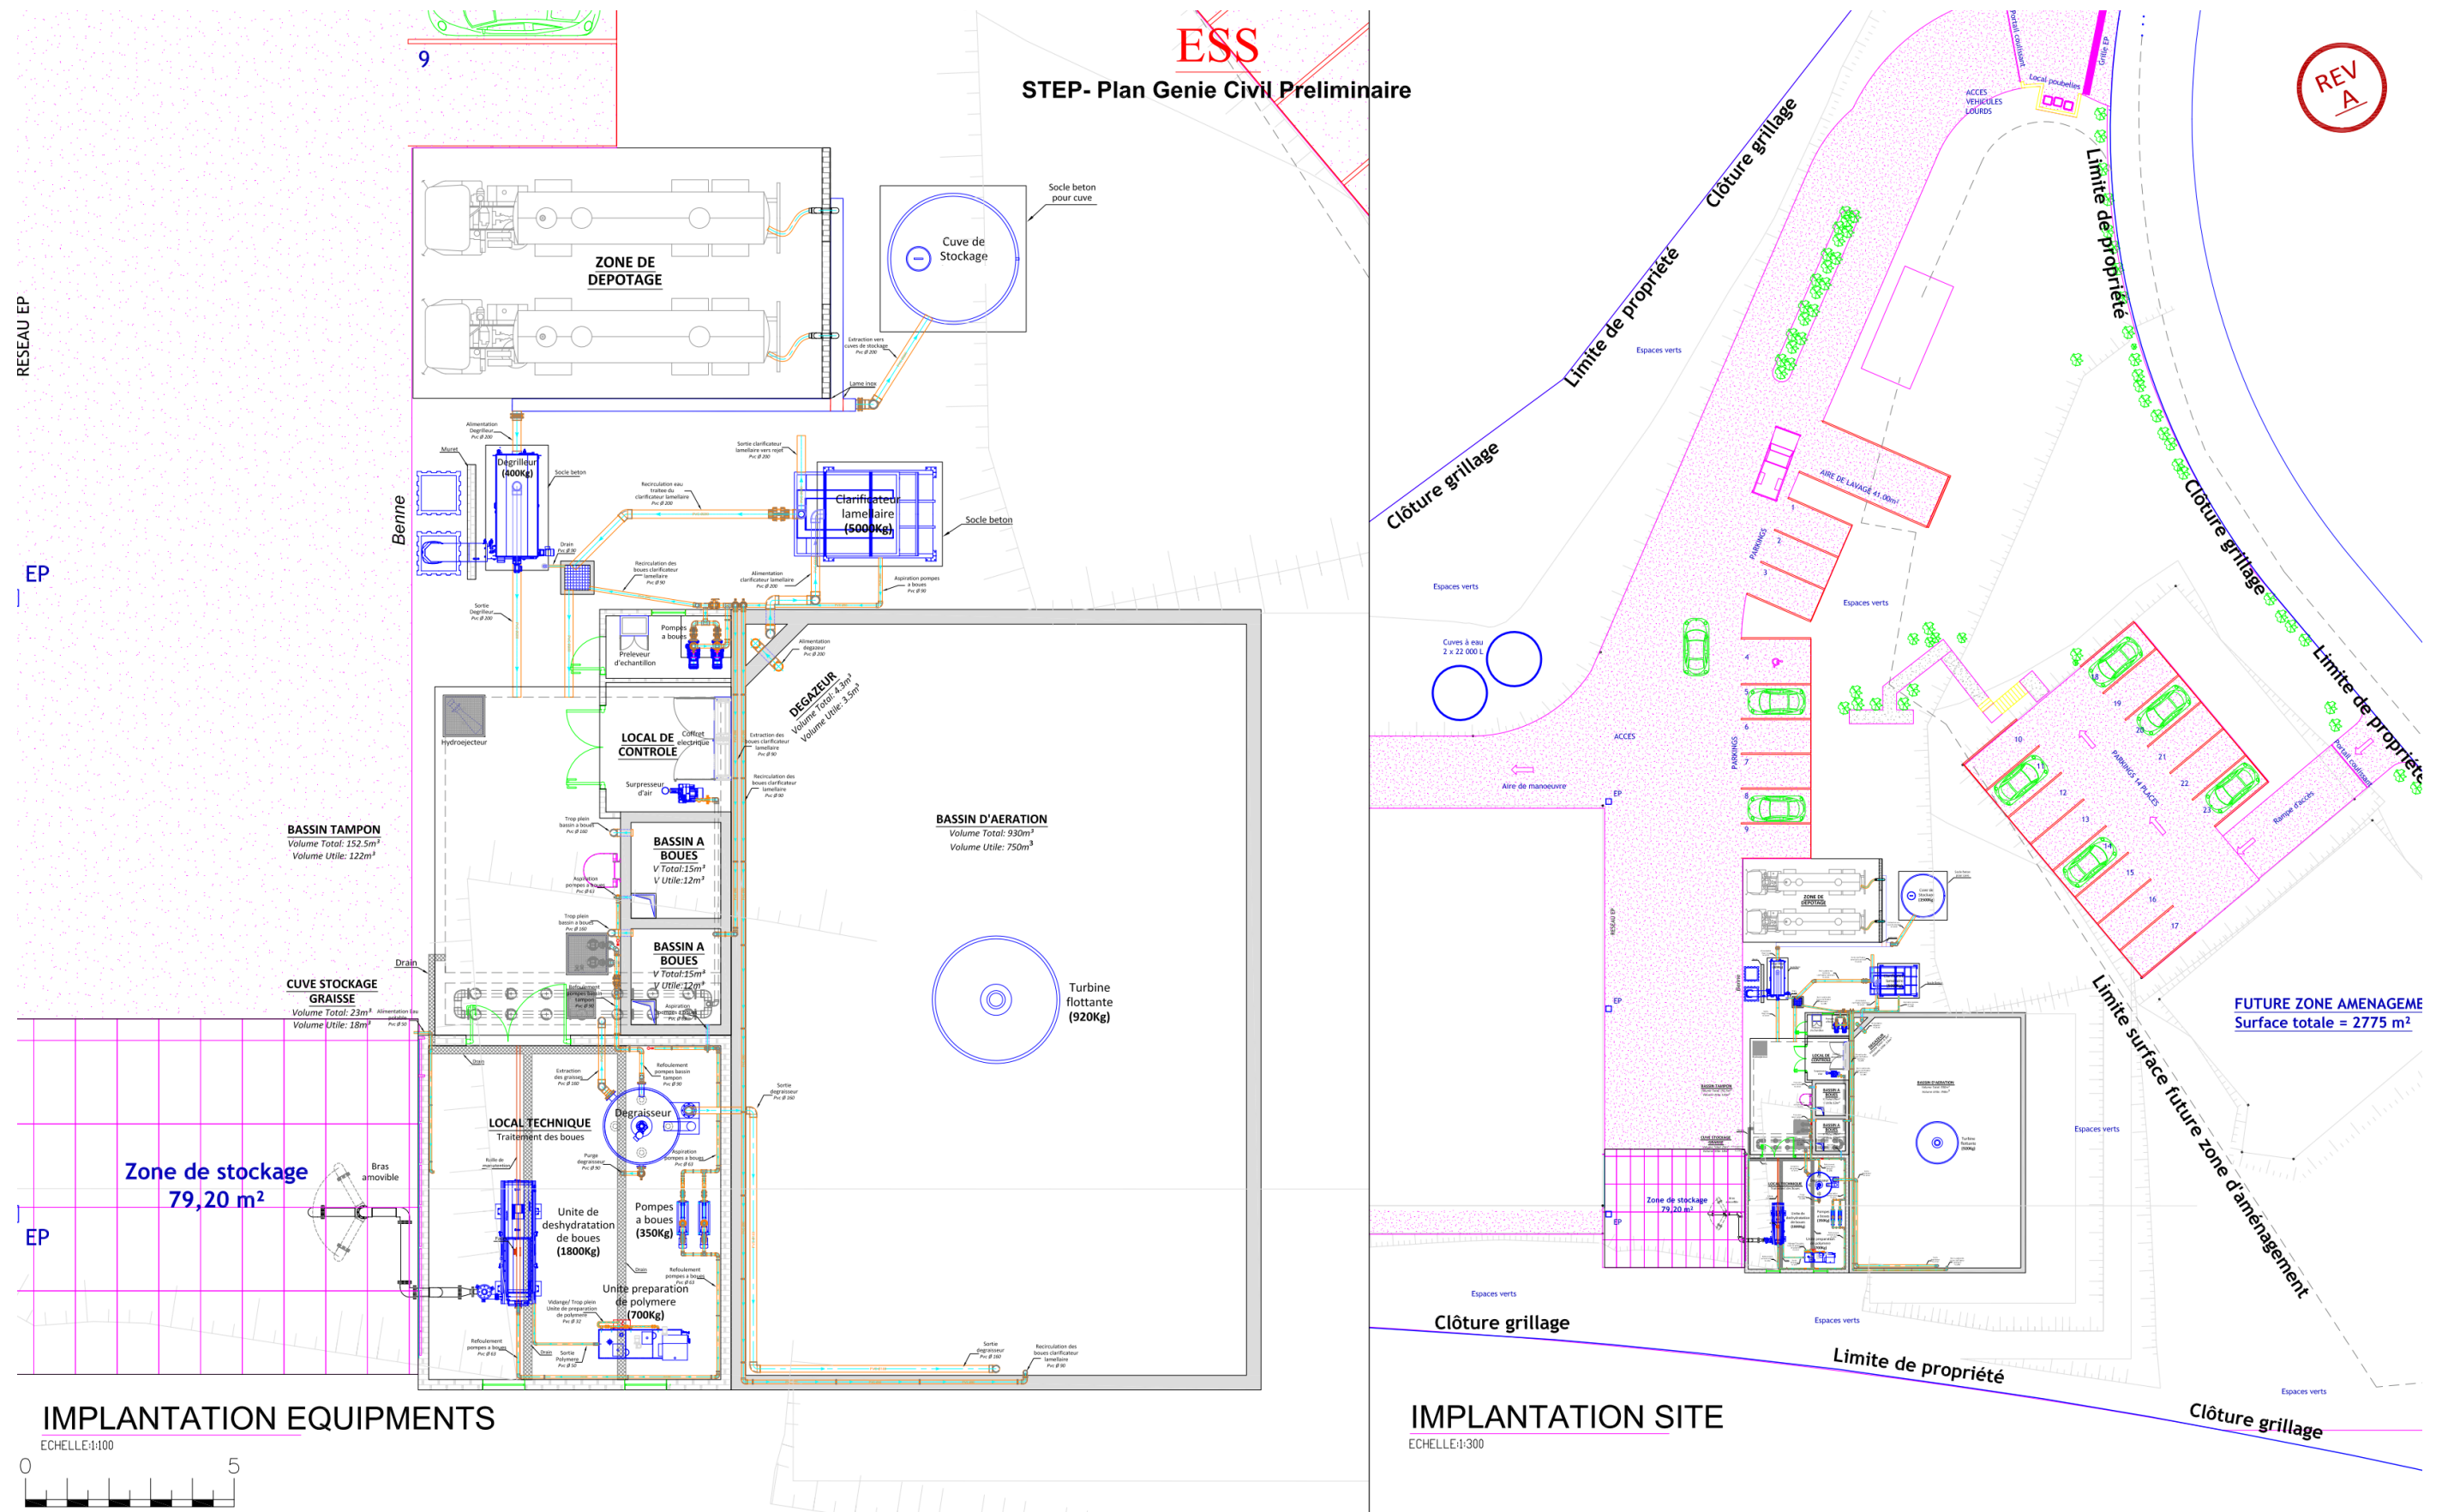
Plan d'implantation de la station de traitement des boues de vidanges
